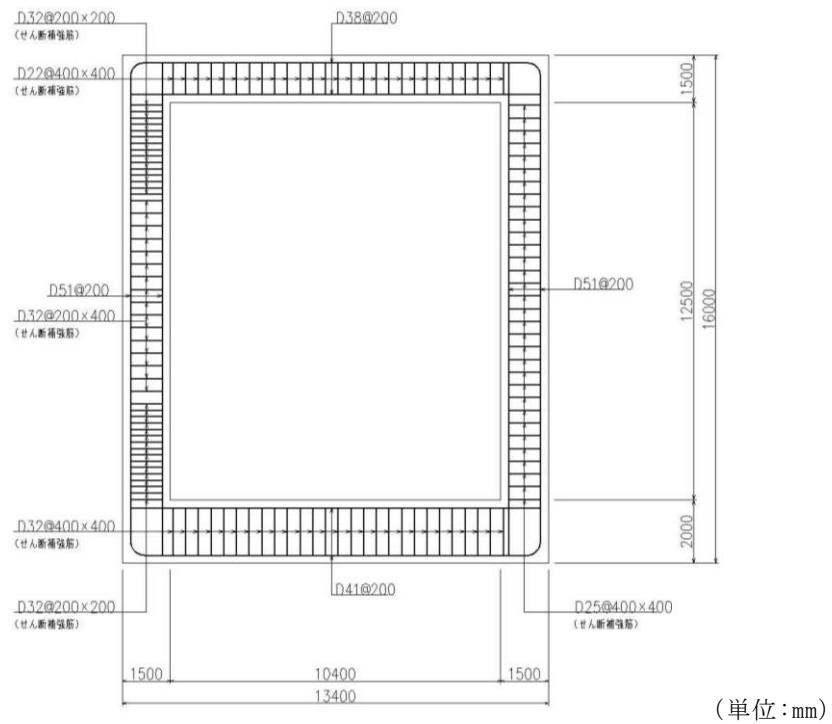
低圧原子炉代替注水ポンプ格納槽 概略配筋図 (B-B 断面)
